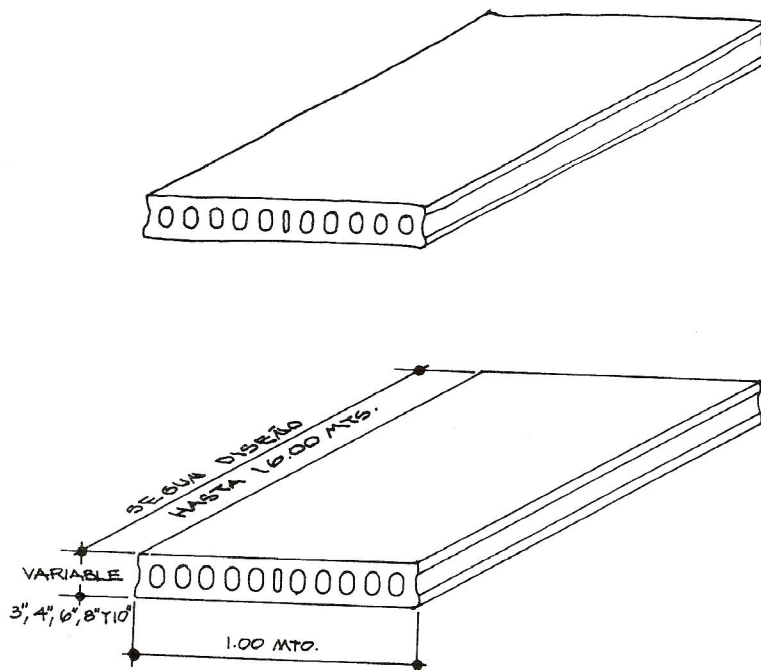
Piezas pretensadas planas aligeradas por ductos longitudinales.
